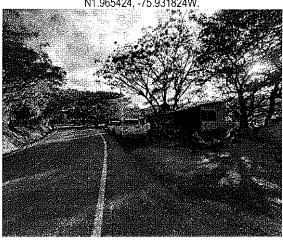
estado de la vía pavimentada existente. N1.965436, -75 931831W
